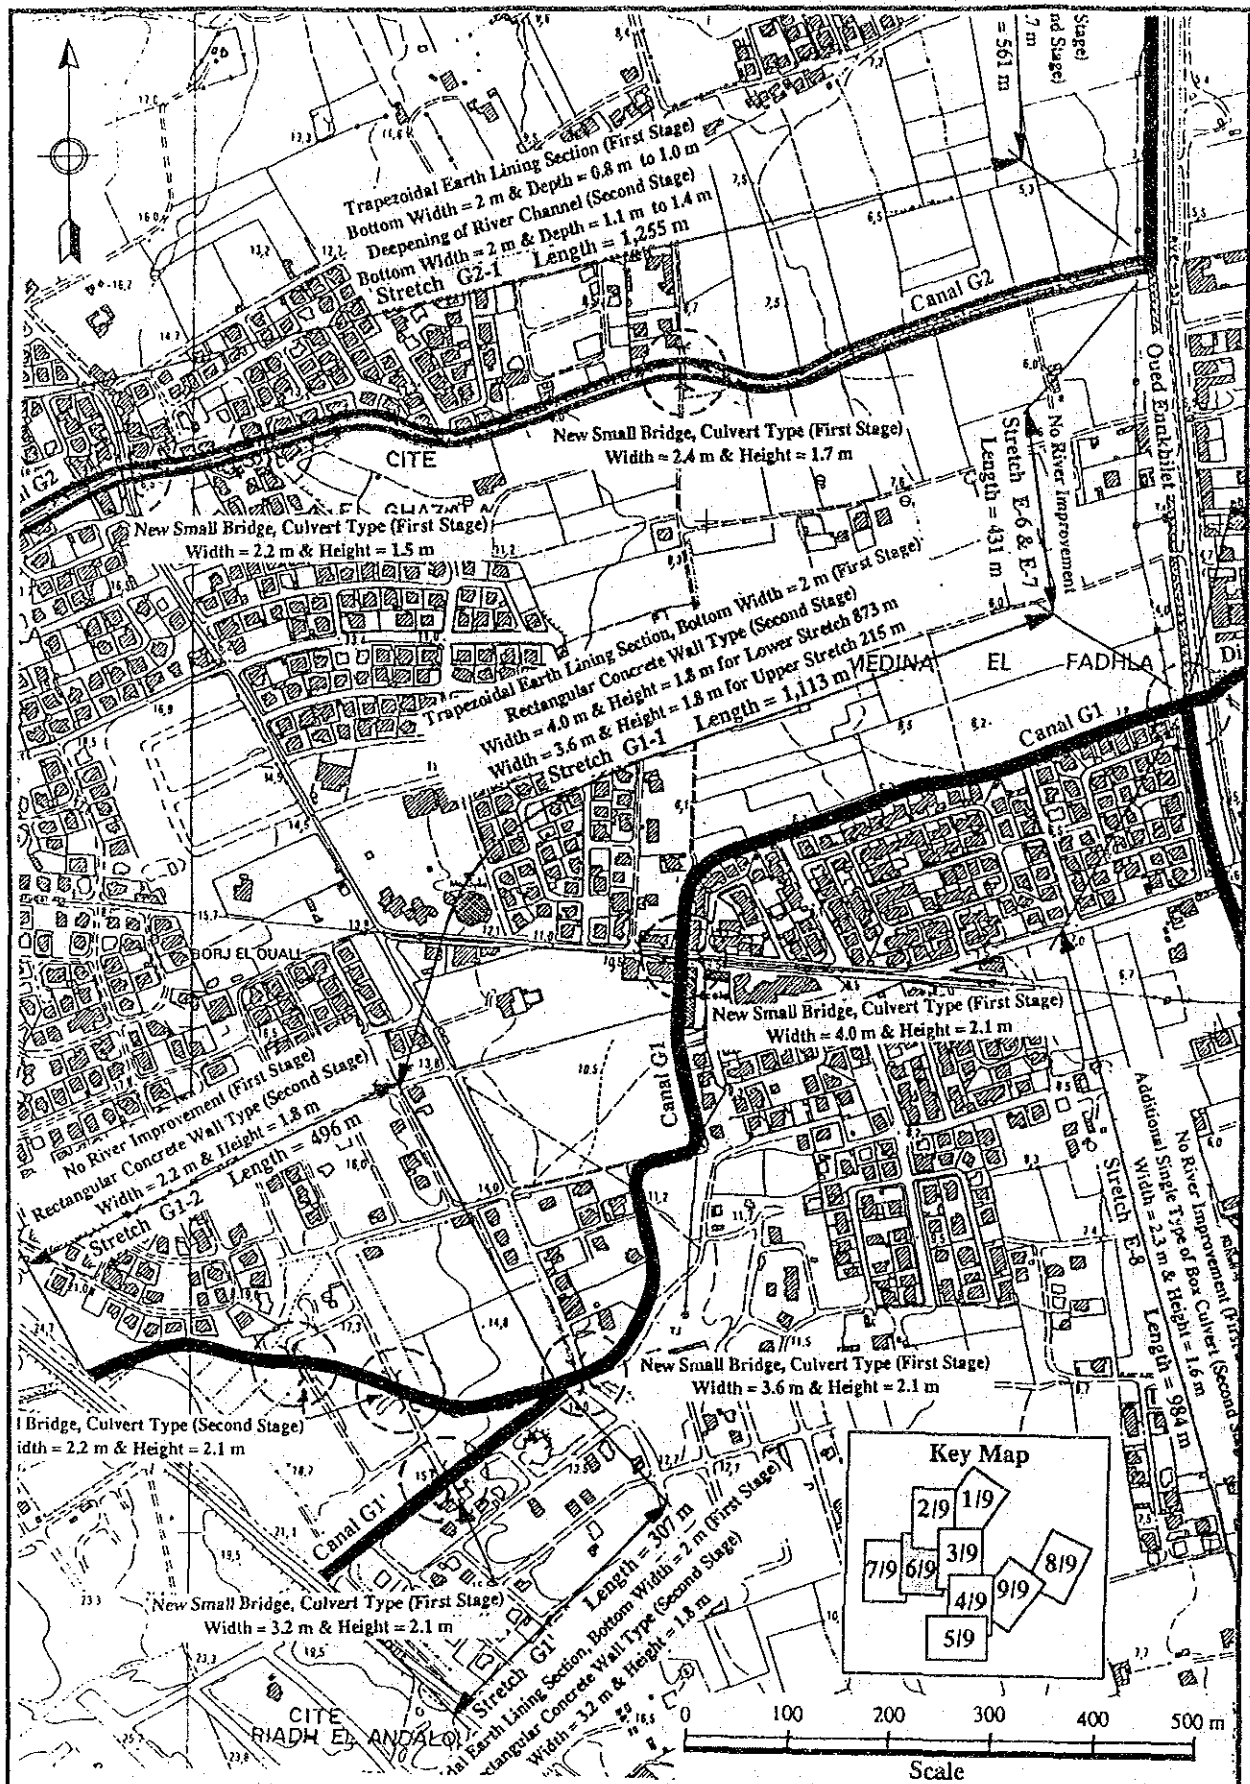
Tracé en plan de la variante d'aménagement de l'Oued Ennkhiilet (6/9)
